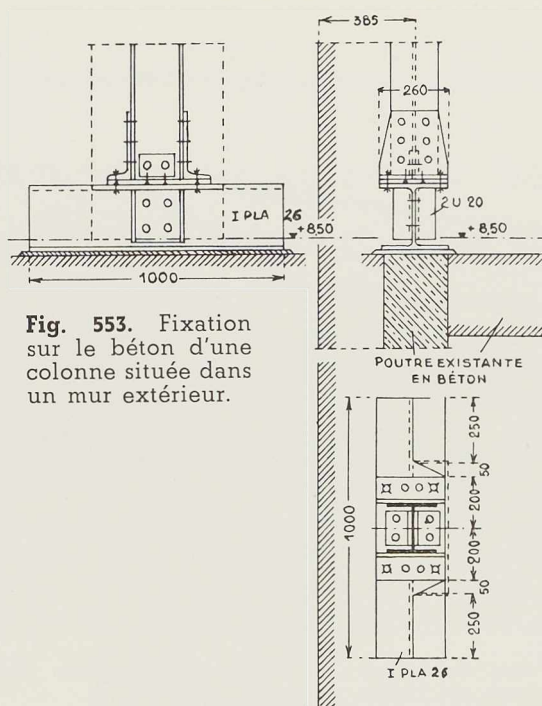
Fixation sur le béton d'une colonne située dans un mur extérieur.
